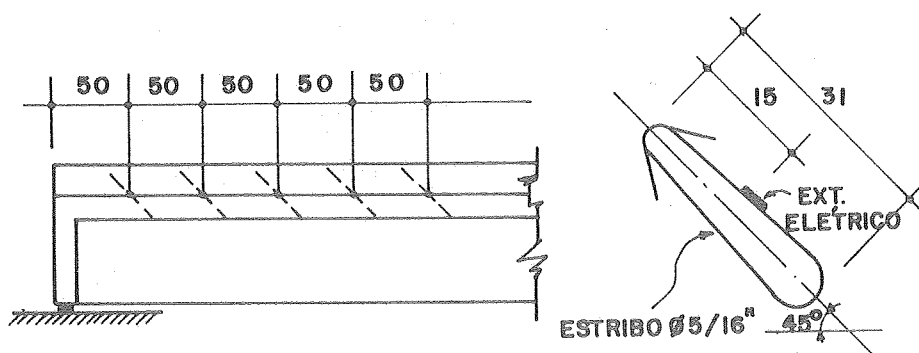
INSTRUMENTAÇÃO DA ARMADURA DE LIGAÇÃO LAJE-VIGA PRÉ-MOLDADA
